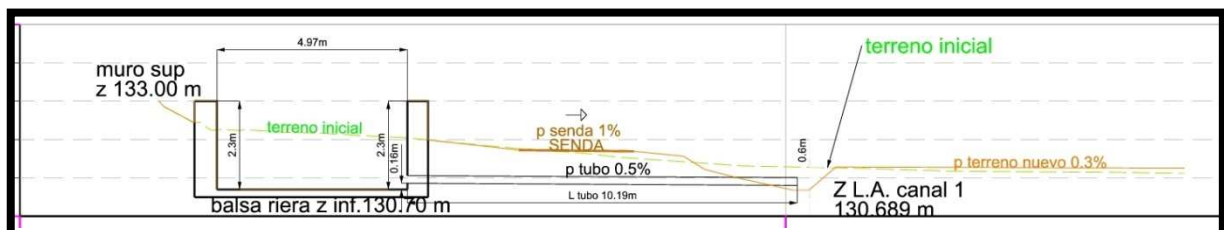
Detalle conexión balsa riera canal 1.
